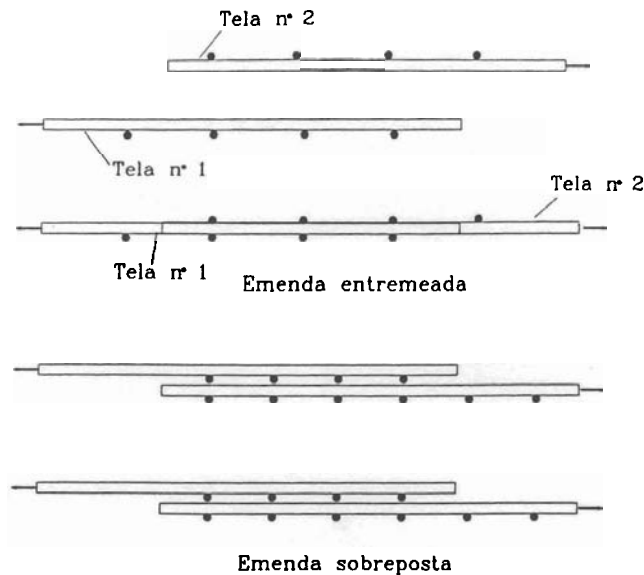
Emenda de tela soldada entremeada ou sobreposta
